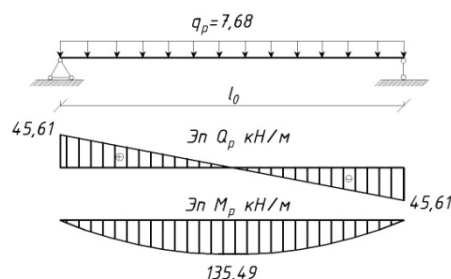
Эпюры моментов и поперечных сил от расчетной нагрузки
